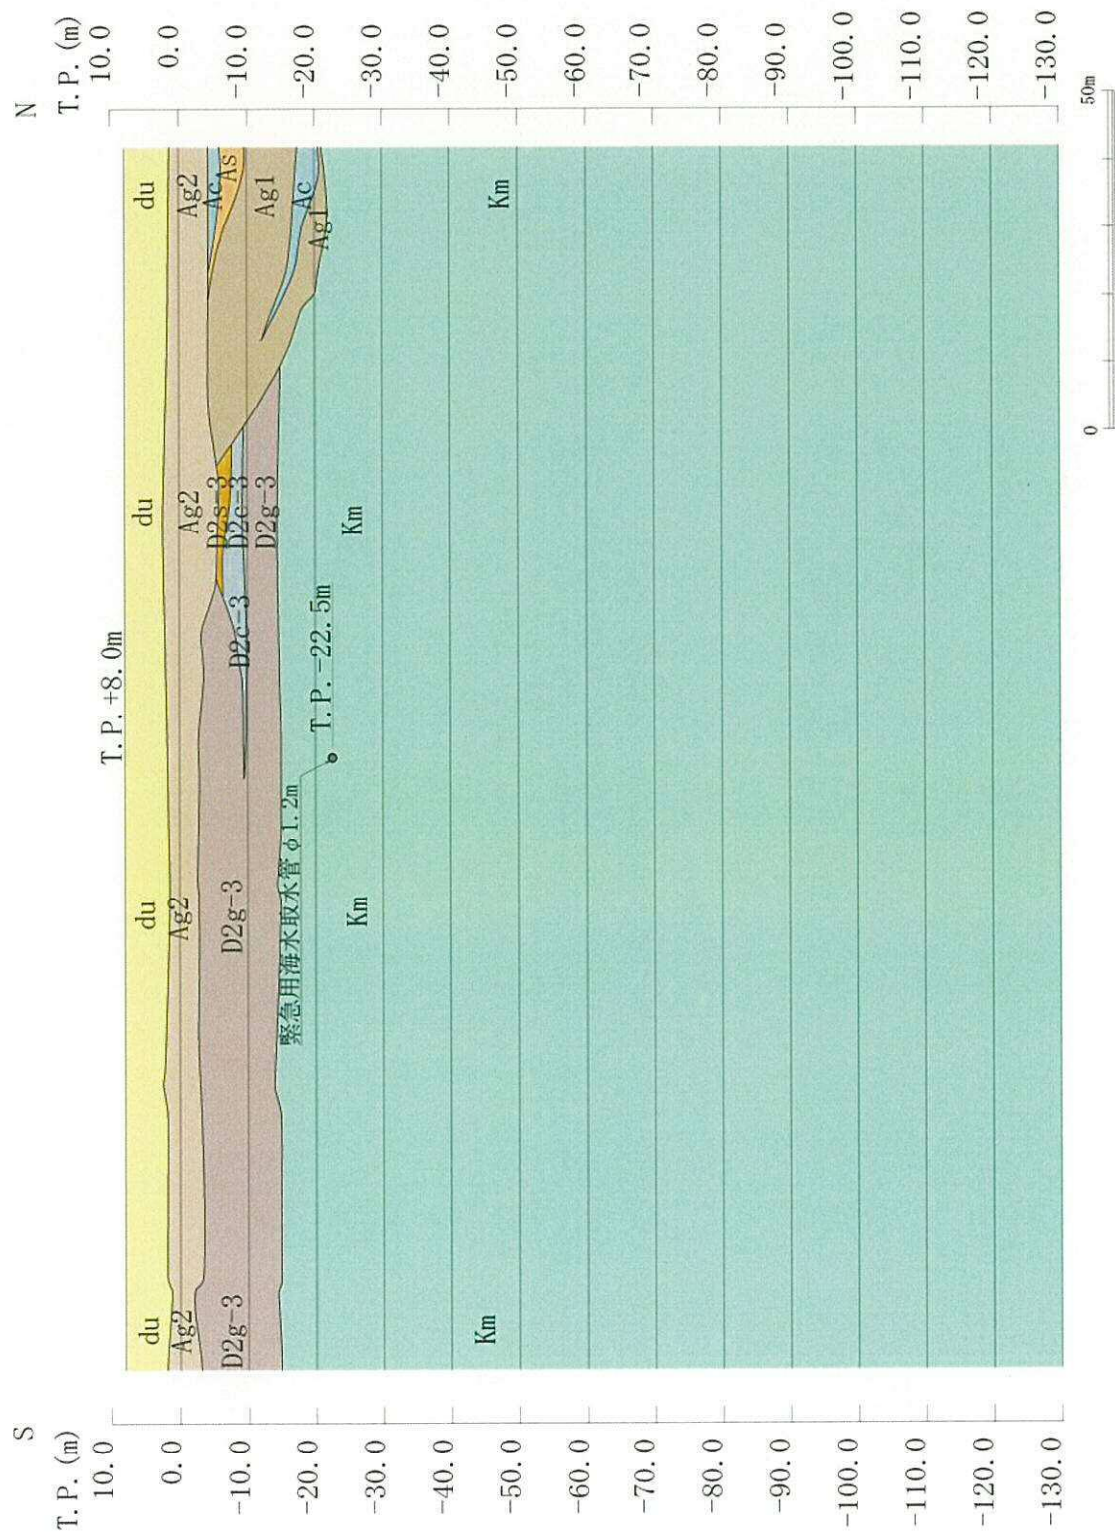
紧急用海水取水管 横断面图 (②-②断面)
